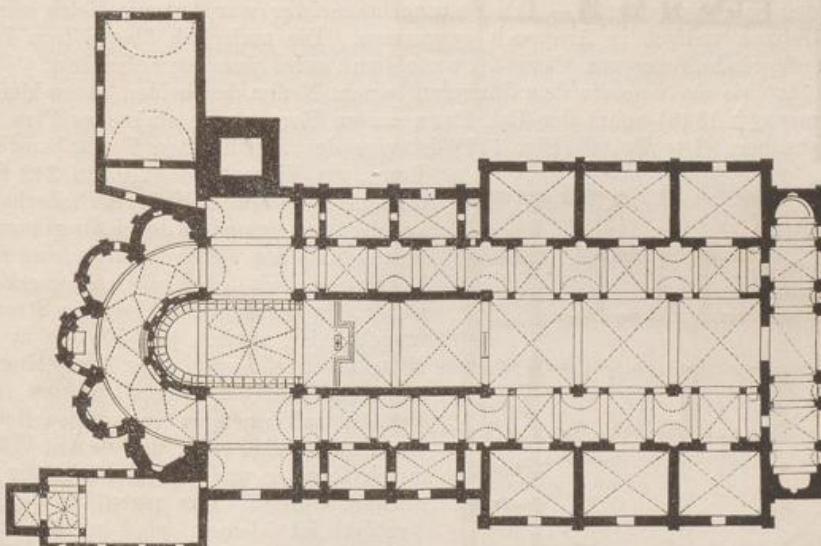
Grundriss der Kirche in S. Benedetto. (M. Lohde.)
